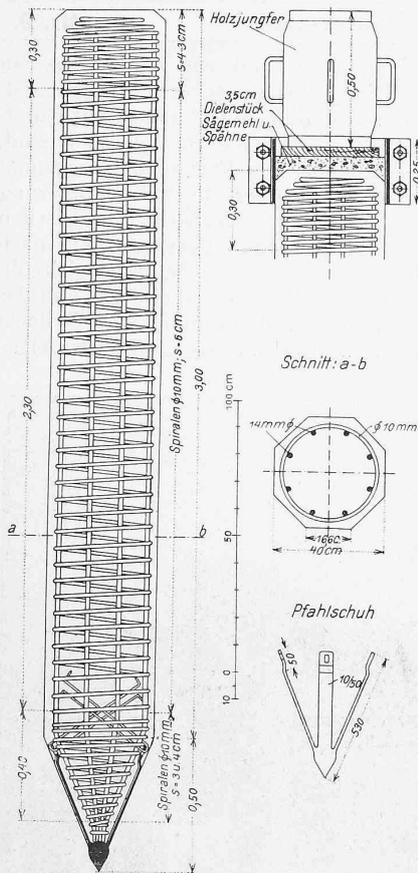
Eisenbetonpfahl. — 1 : 25.
